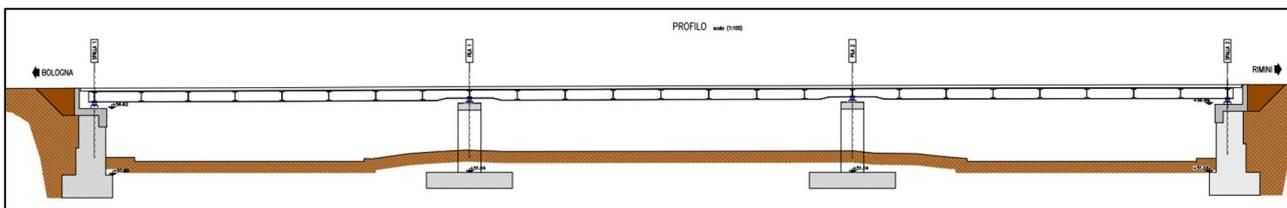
Sezione longitudinale del viadotto su Via Masserenti
